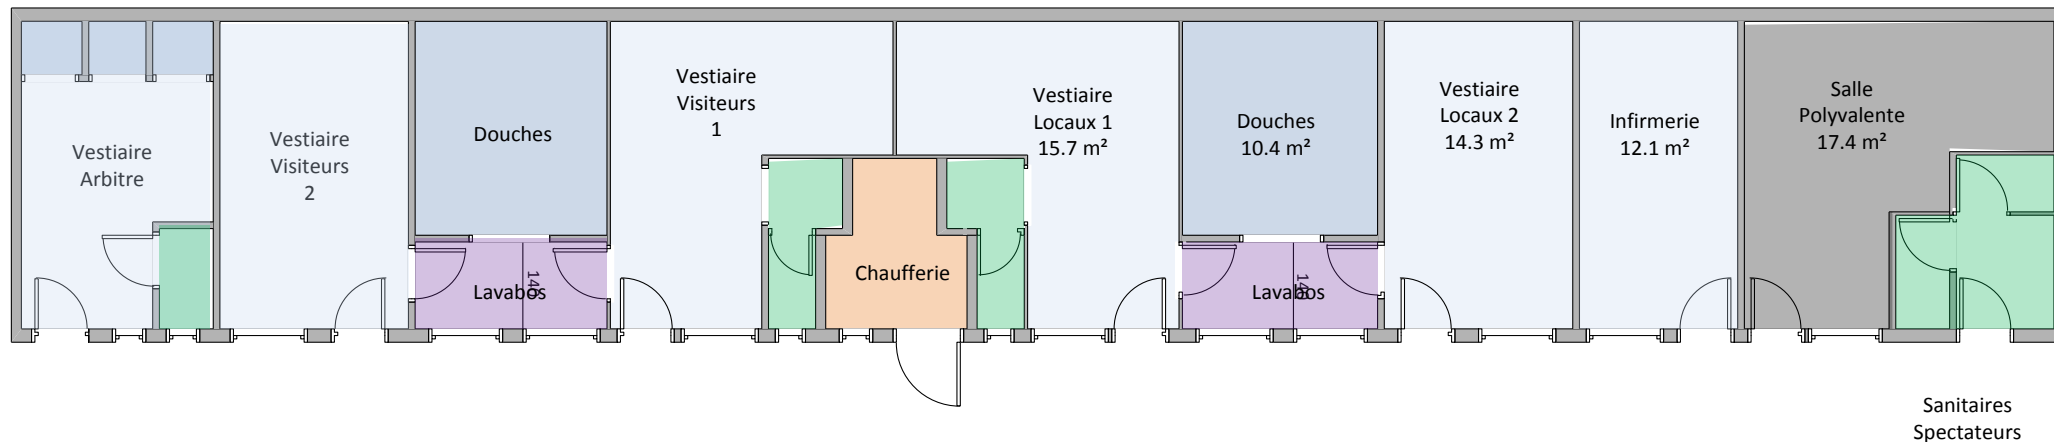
Plan des vestiaires locaux et visiteurs du club de foot.
